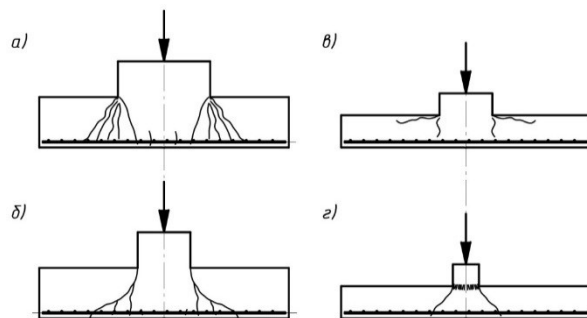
Схемы трещинообразования, предшествующие продавливанию железобетонных плит
